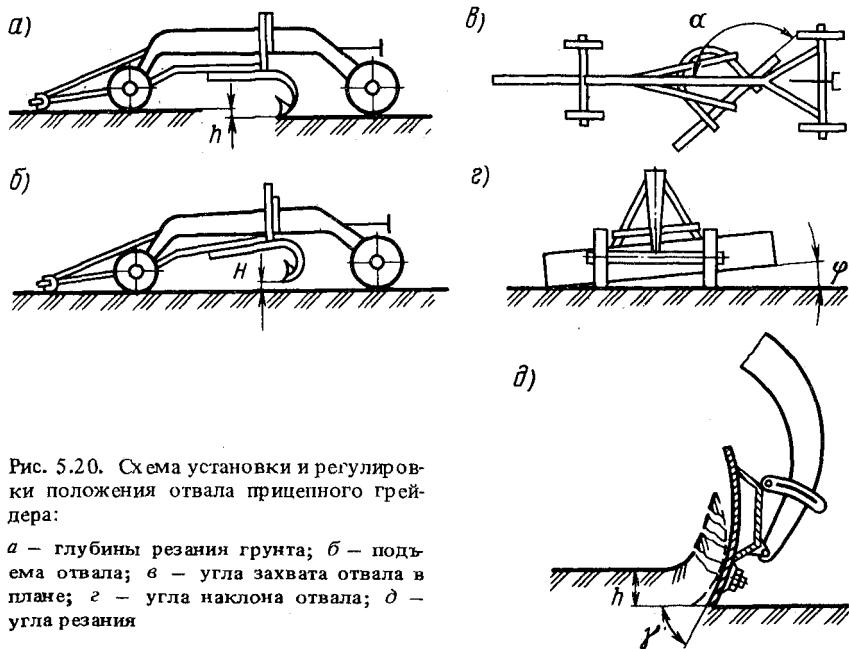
Схема установки и регулировки положения отвала прицепного грейдера:
